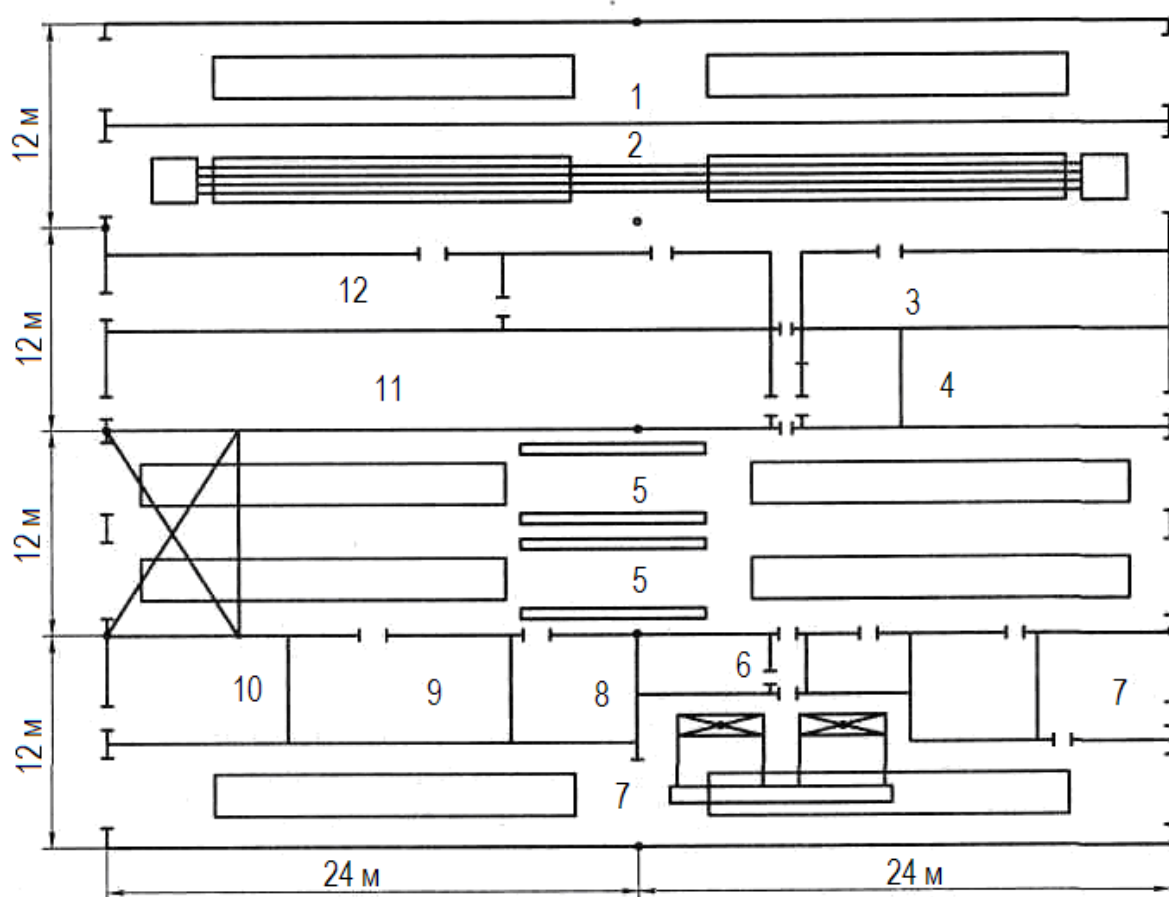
Компоновочный план вспомогательного корпуса АТП:
